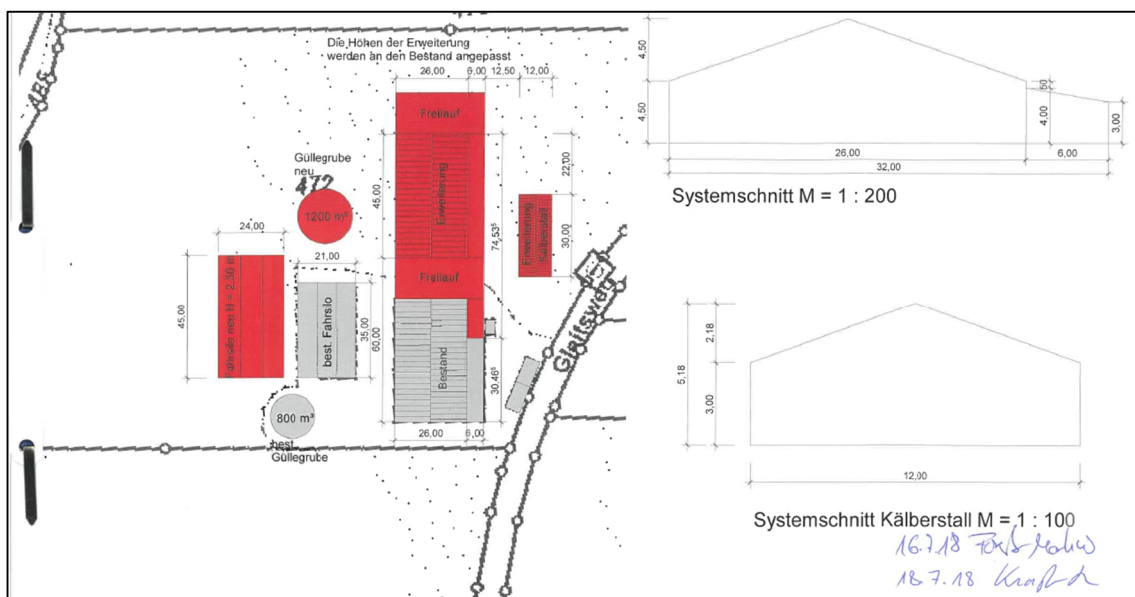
Lageplan mit Erweiterungsabsichten des Betriebs Forster /8/
